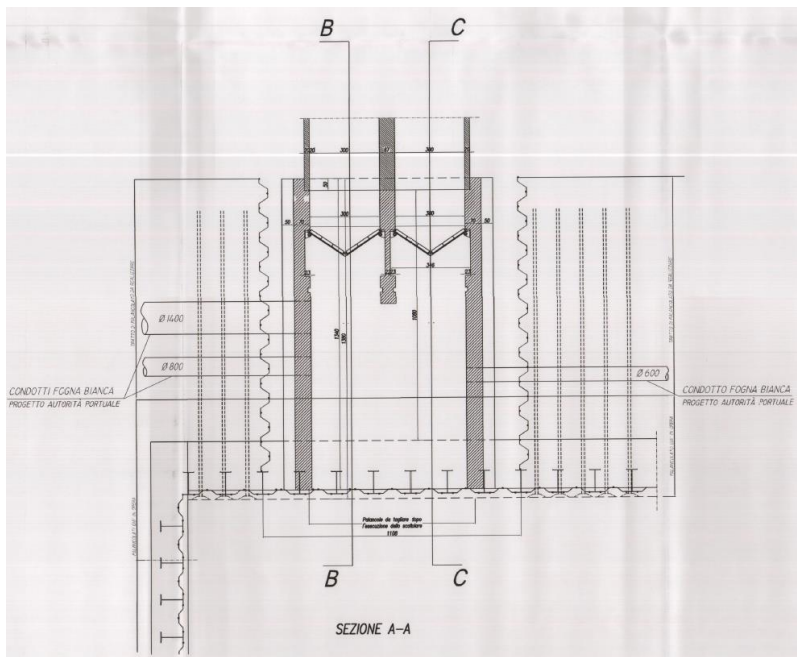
Pianta manufatto di sbocco scarico depuratore
